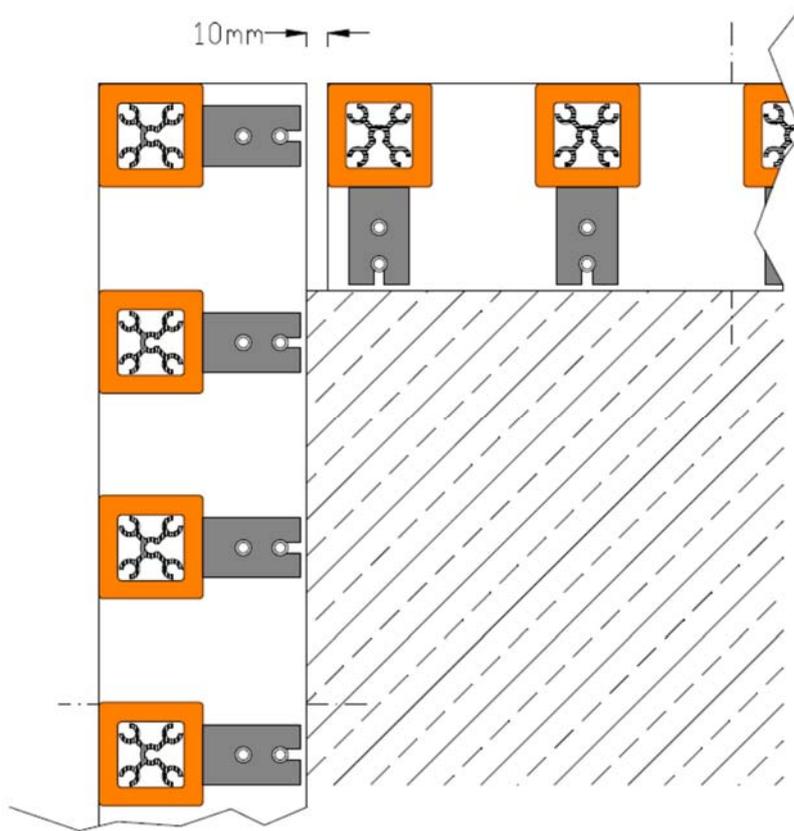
a – Pose verticale, angle, Barro à fleur (profil de section rectangulaire)
